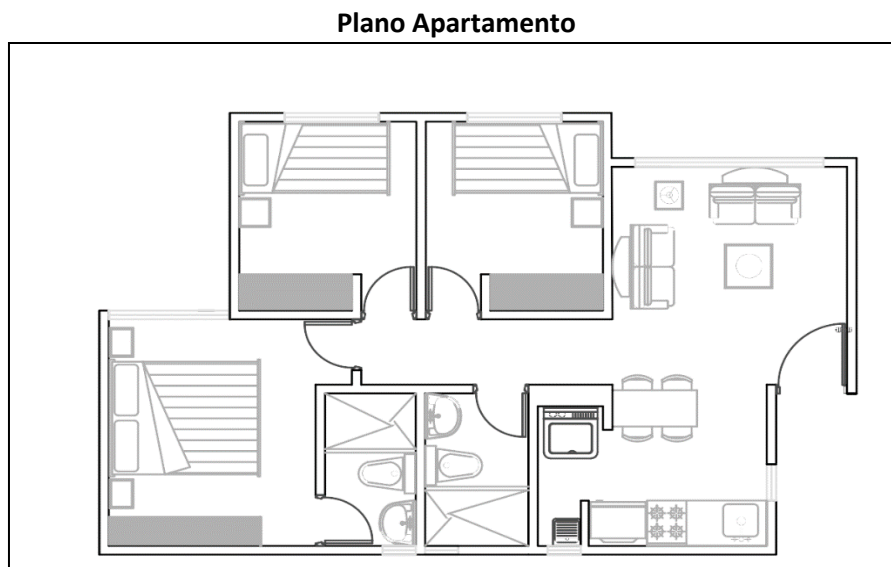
Plano Apartamento. Fuente. Estudio Técnico
